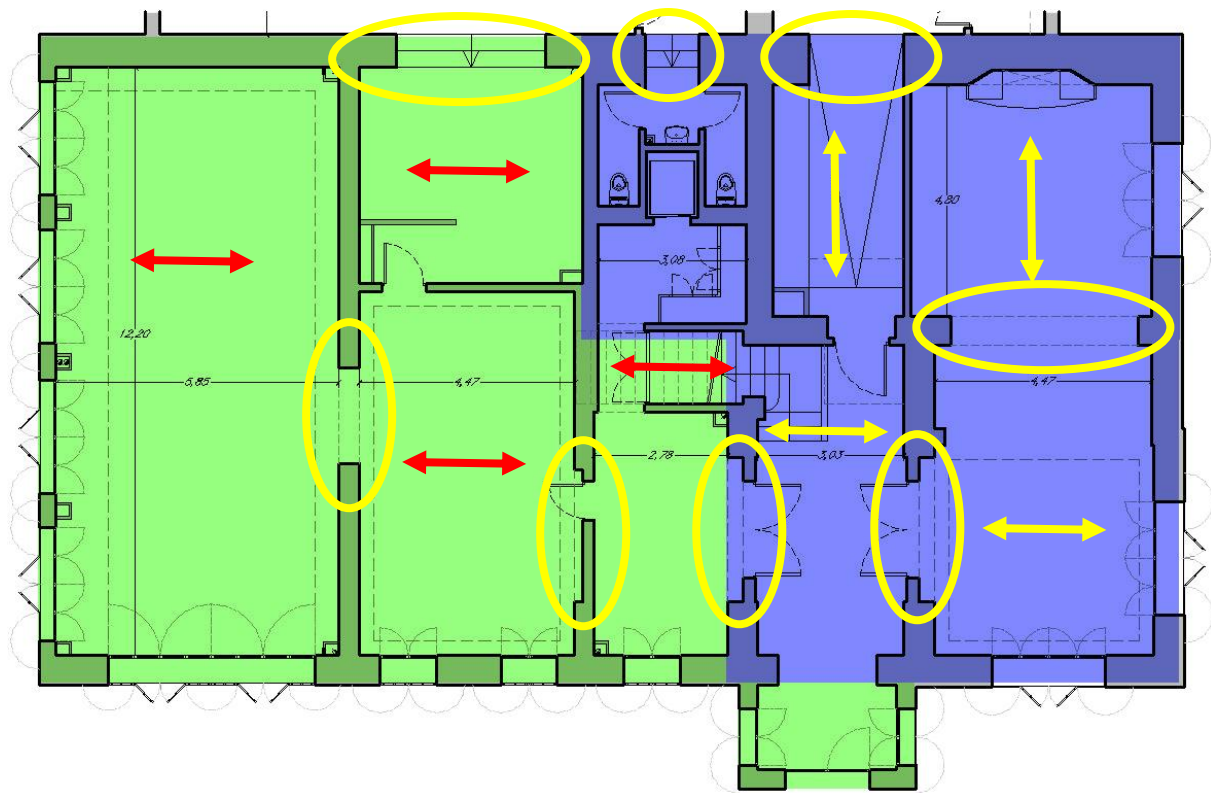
Plano planta baja (Fuente: Propia)
